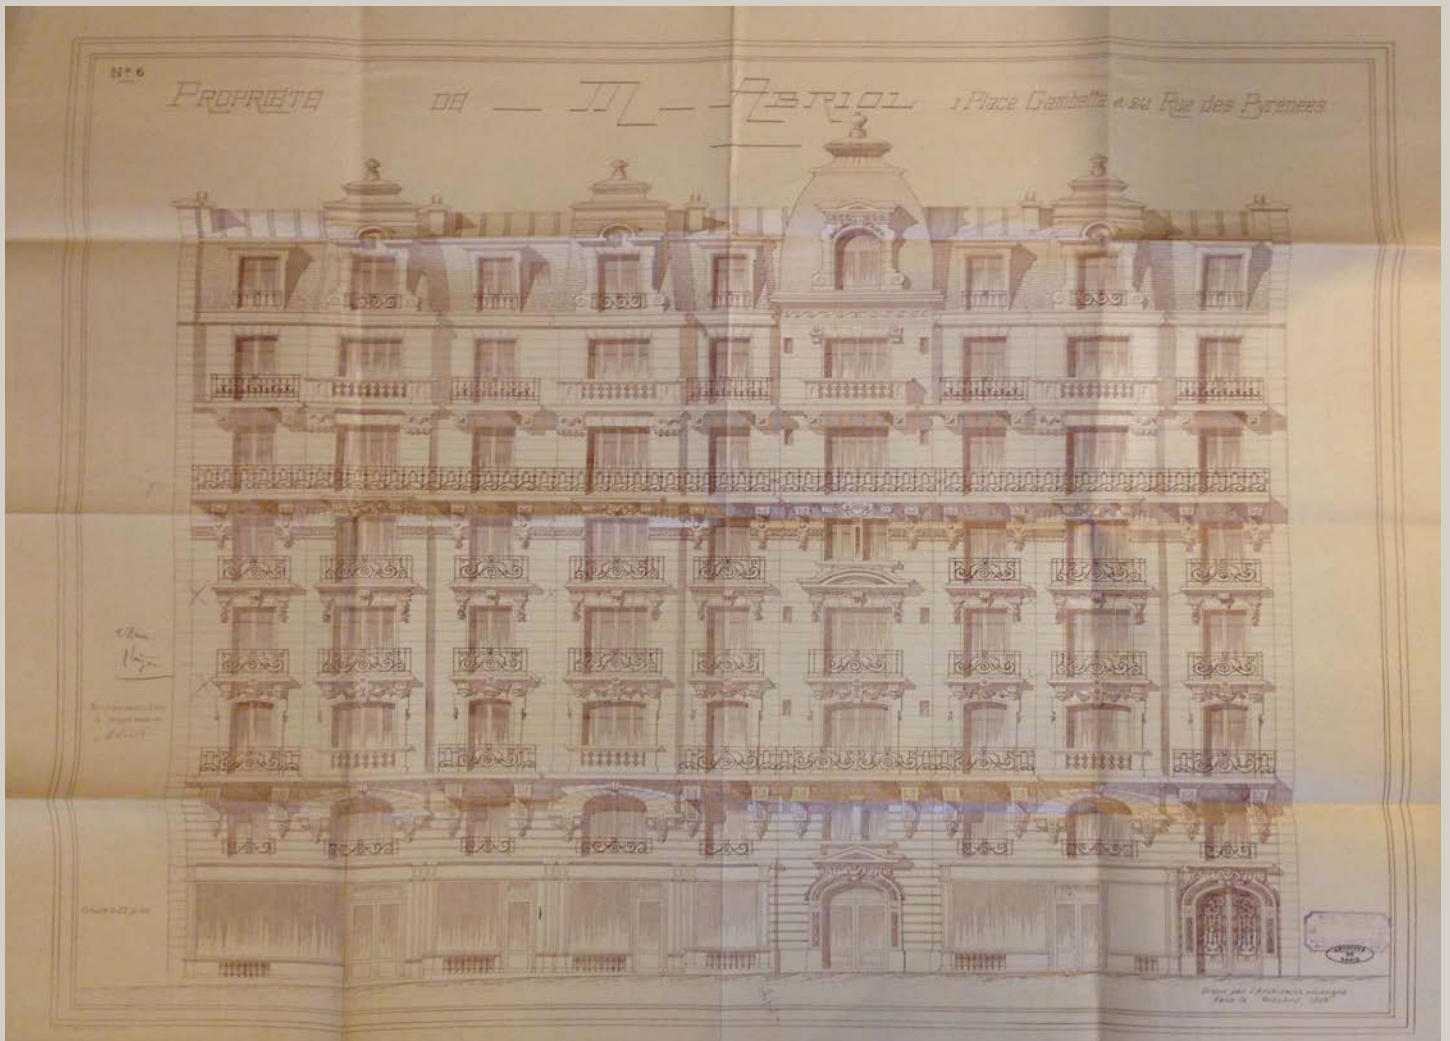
Elevation projeté en 1908 par l'architecte Emile Benoist pour l'immeuble 1, place Gambetta.
